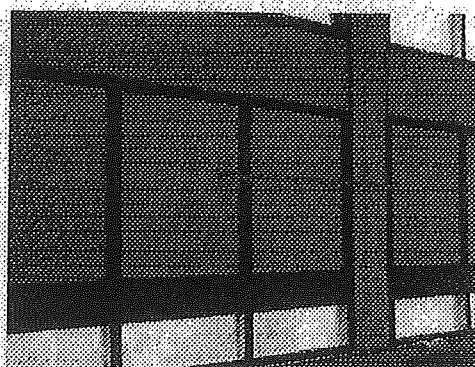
brontype 03, Cementgebonden sandwichpaneel
